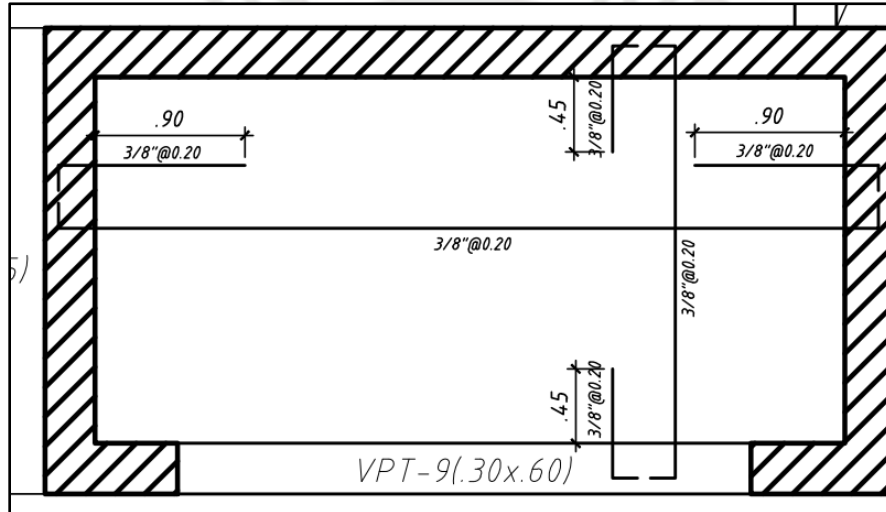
Distribución final del refuerzo en losa maciza entre ejes 2 y 4
